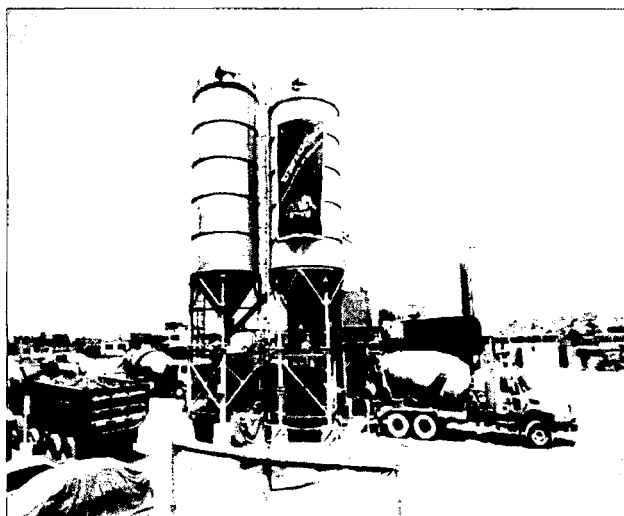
Equipo de preparación de concreto para vigas prefabricados en la planta Bayóvar
